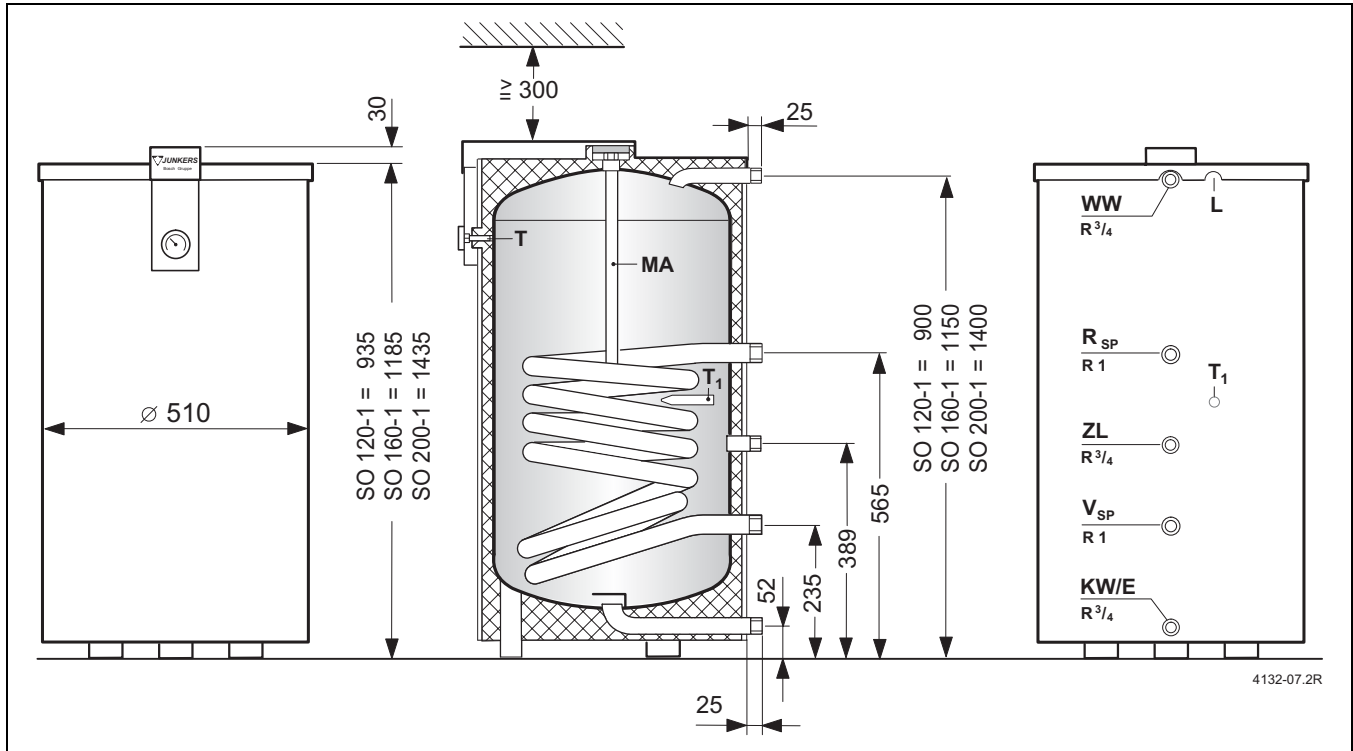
Bau- und Anschlussmaße SO 120/160/200-1
